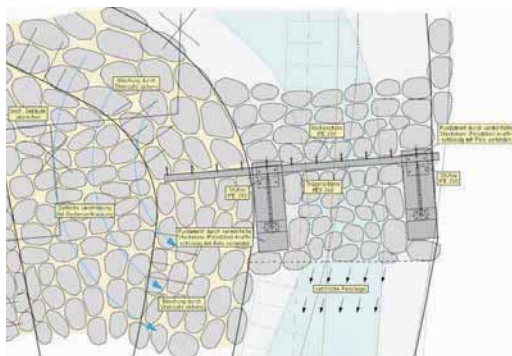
Lageplan Wildholzrechen – Bauart Stabrechen mit Gründung auf Mikropfählen
